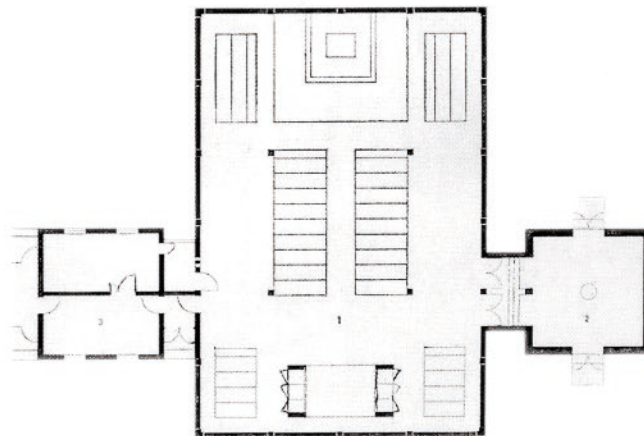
St. Christoforus in Köln-Niehl, 1957 – 1960, Grundriss, aus: R. S., *Kirchenbau*, Heidelberg 1960, S. 297
